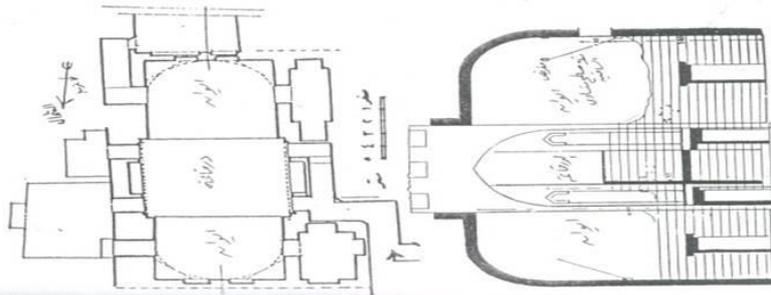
مكرر) قصر الأخيضر، مسقط أفقي للحمام - (عن كريزول).
